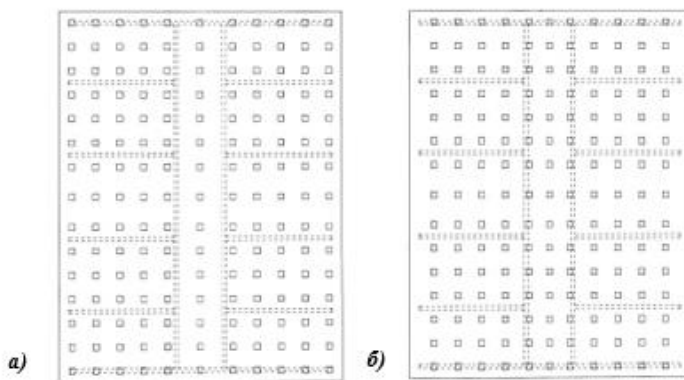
Схема свайно-плитного фундамента и несущих стен многоэтажного здания: а - без смещения осей свайного поля; б – со смещением осей свайного поля
